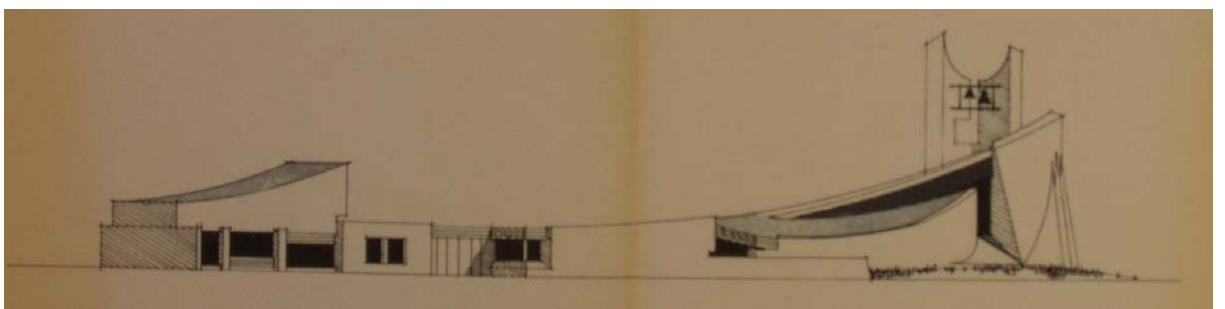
Élévation façade sud 02-09-66 (AHDL P 290)
